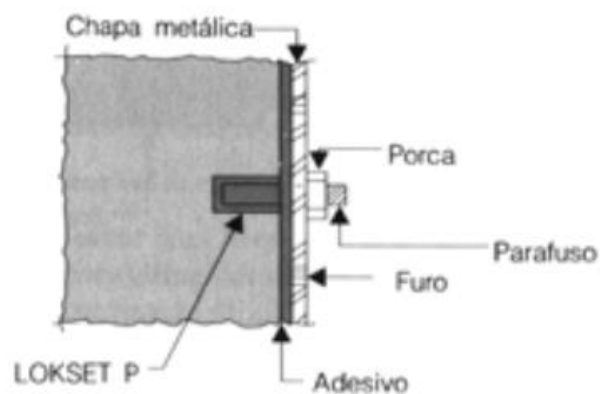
Pormenor da fixação da chapa metálica à viga. (Fernando G., et al 2002)
